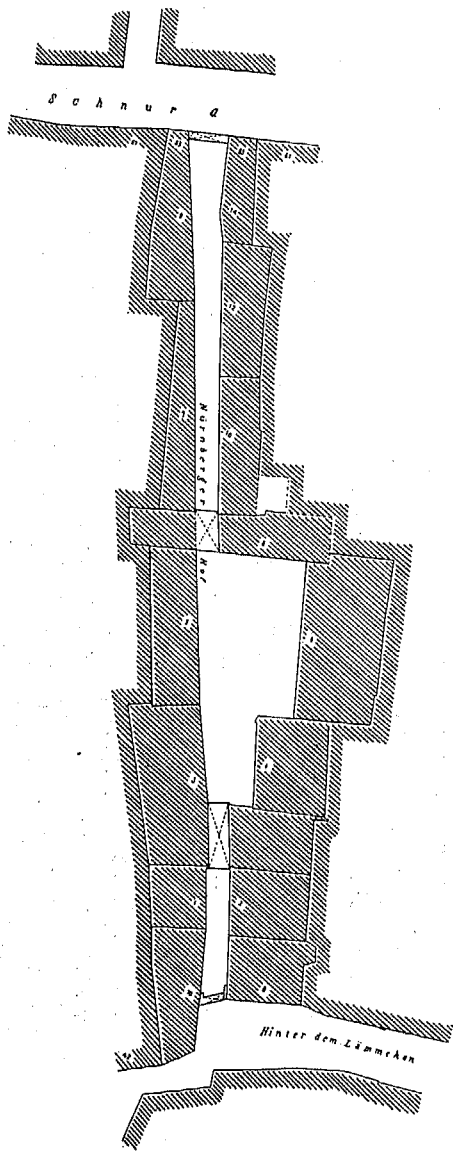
Nürnberger Hof; Grundriss nach dem Katasterplane. 1:1000.
